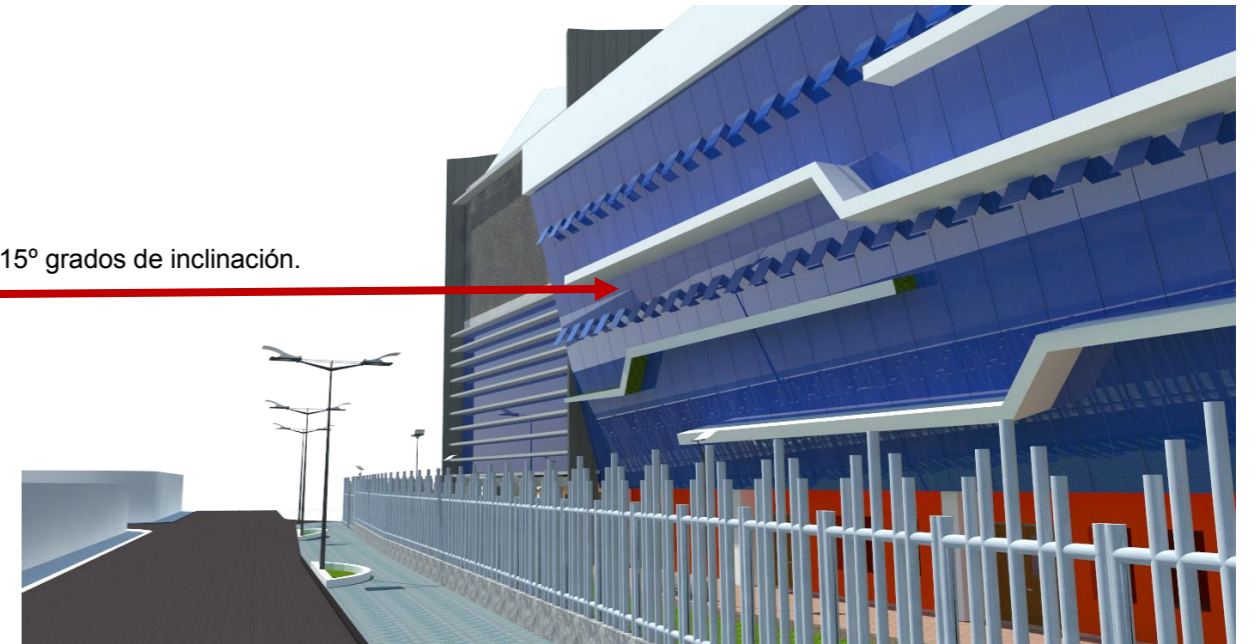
Vista fachada Sur de Danza, Teatro y Música.
